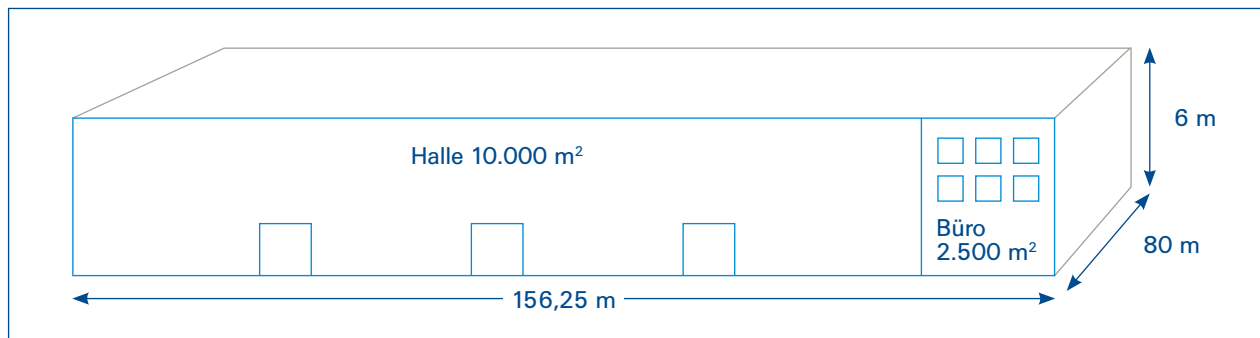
Produktionshalle - Ausstattungsklasse B (Quelle: IndustrialPort)
